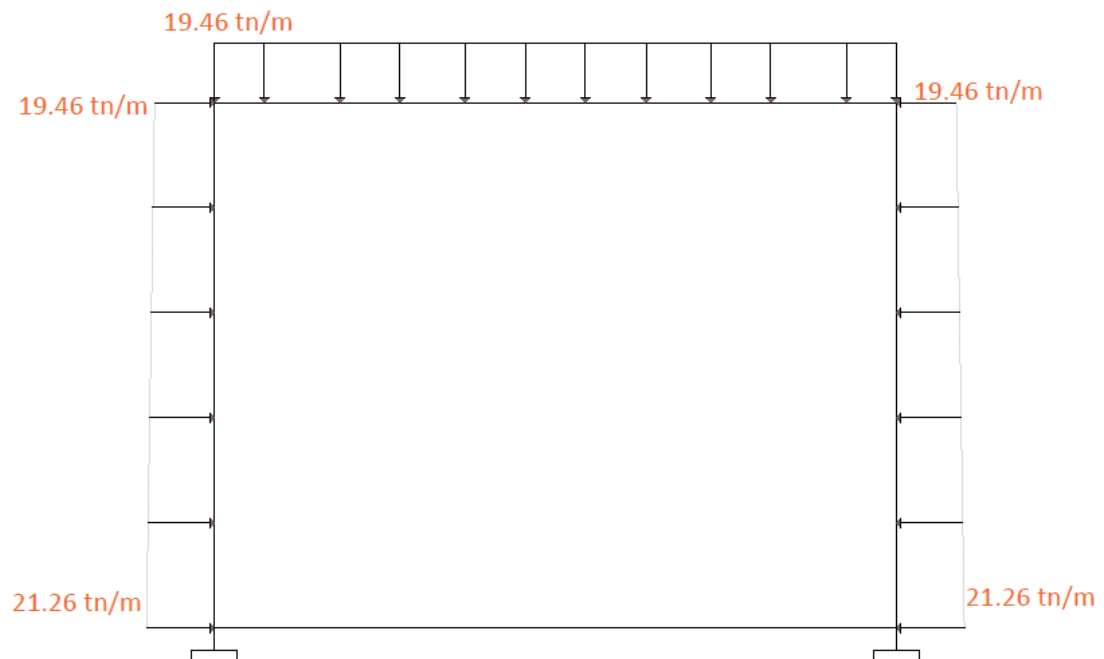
Cargas Que Actúan En la Alcantarilla
